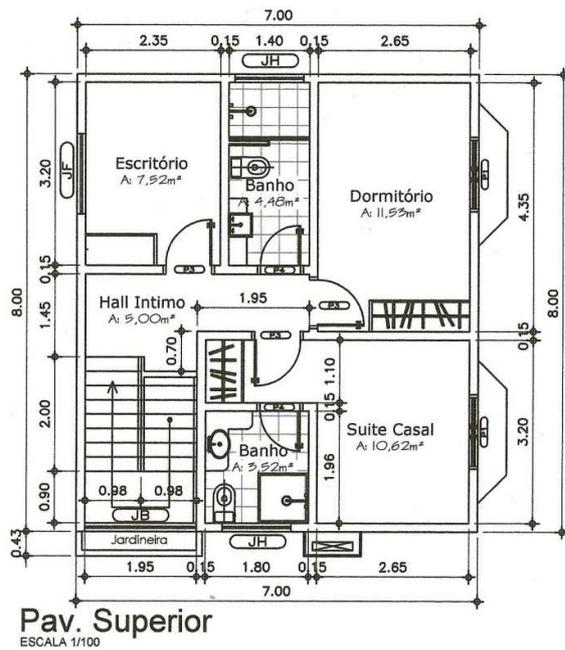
Planta baixa do pavimento superior para confecção da maquete e aprendizado de conteúdos de matemática.
